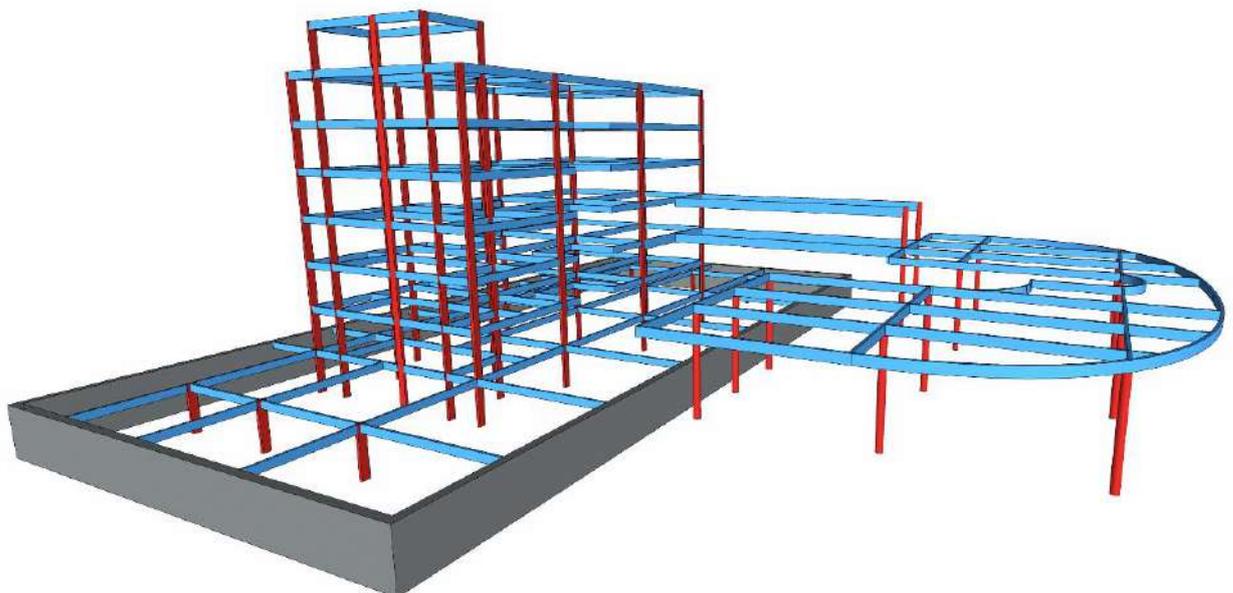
Estrutura metálica. Fonte: Autor, 2021
